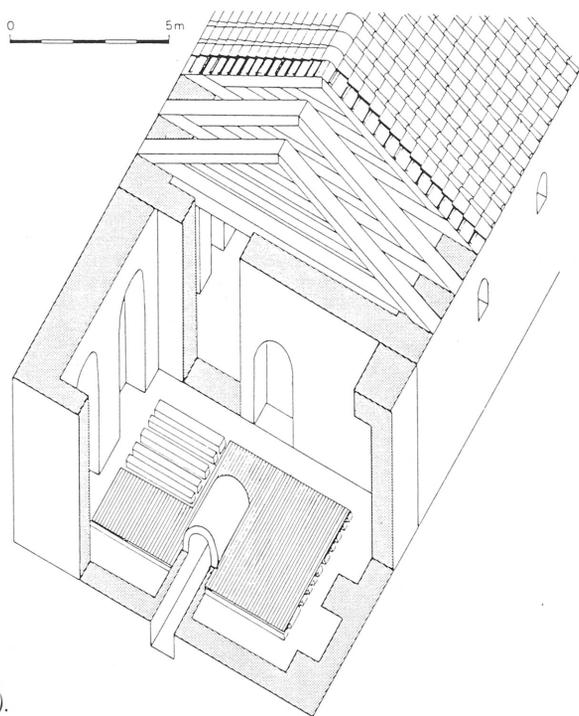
Petegem, Grundriß (Umzeichnung nach Callebaut).
